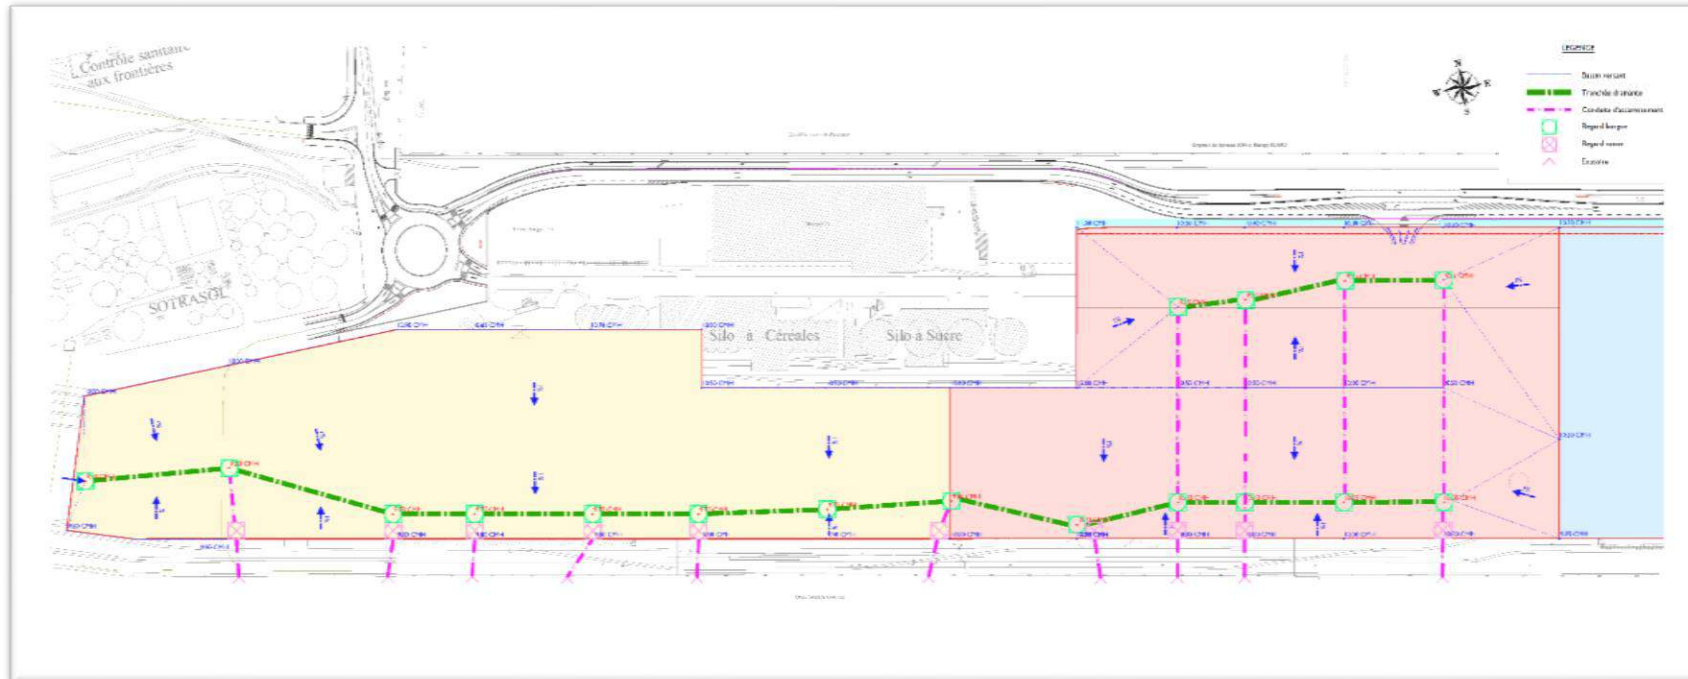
Plan de principe du système d'assainissement des zones sous maîtrise d'ouvrage GPMH
